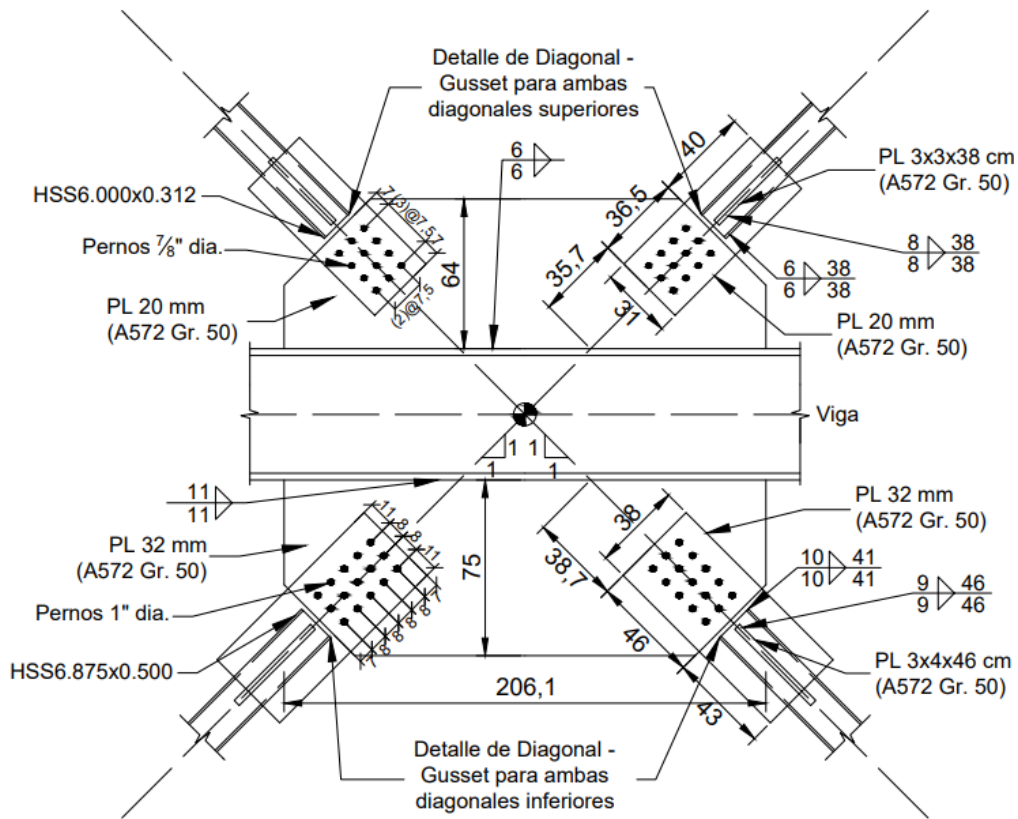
Detalle de conexión emperrada al gusset. Medidas en cm y espesor de soldaduras en mm.
